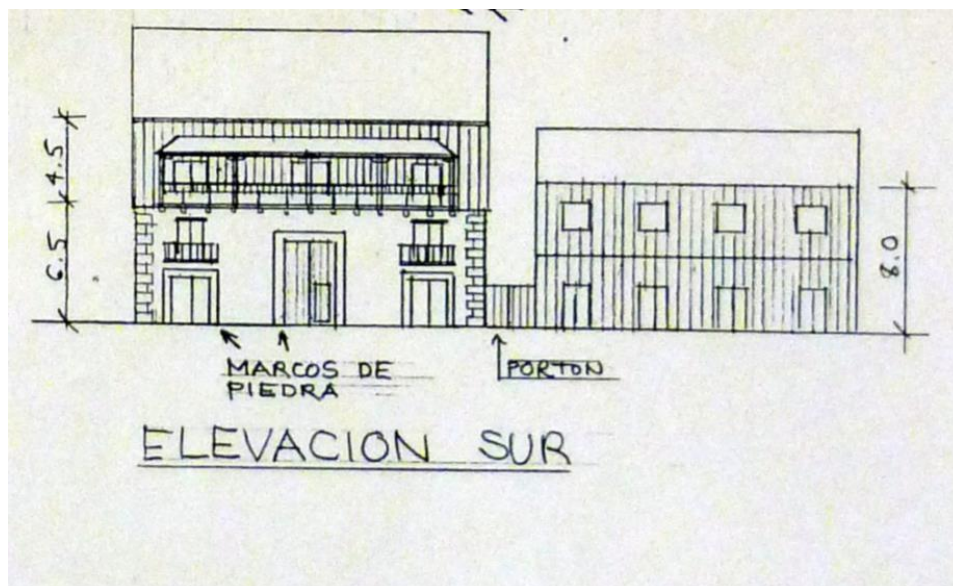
Reconstrucción propuesta por Tejeira Davis de la elevación sur de la Casa Alarcón. Se puede distinguir la planta baja, el entresuelo y alto de madera. (Tejeira Davis, 1994: La ciudad.)
